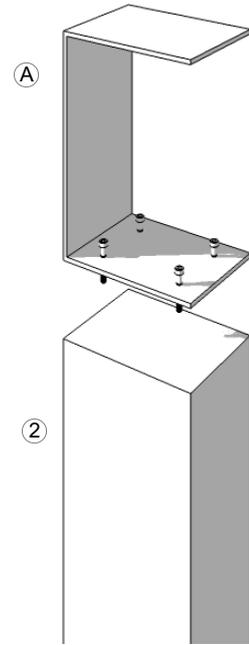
Perspectiva de dois pontos - União entre viga e peça metálica
